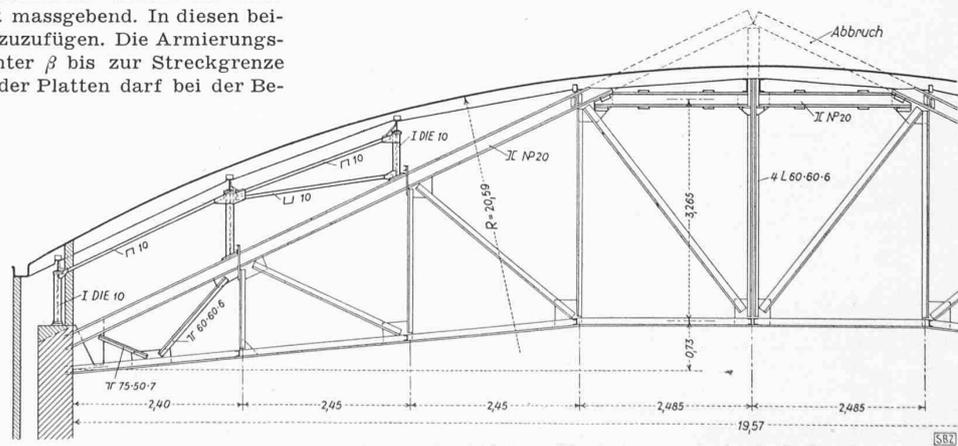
Umgebauter Dachbinder über dem grossen Tonhallsaal. Fein gezeichnete Stäbe alt, dick gezeichnete neu. — Masstab 1:100
